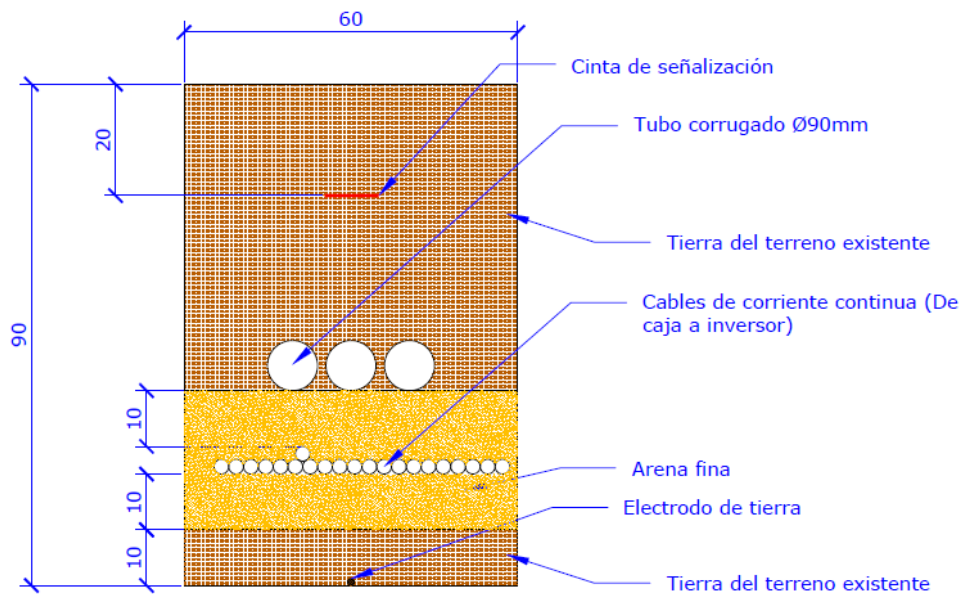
Detalle de zanja (Fuente: Elaboración propia).
